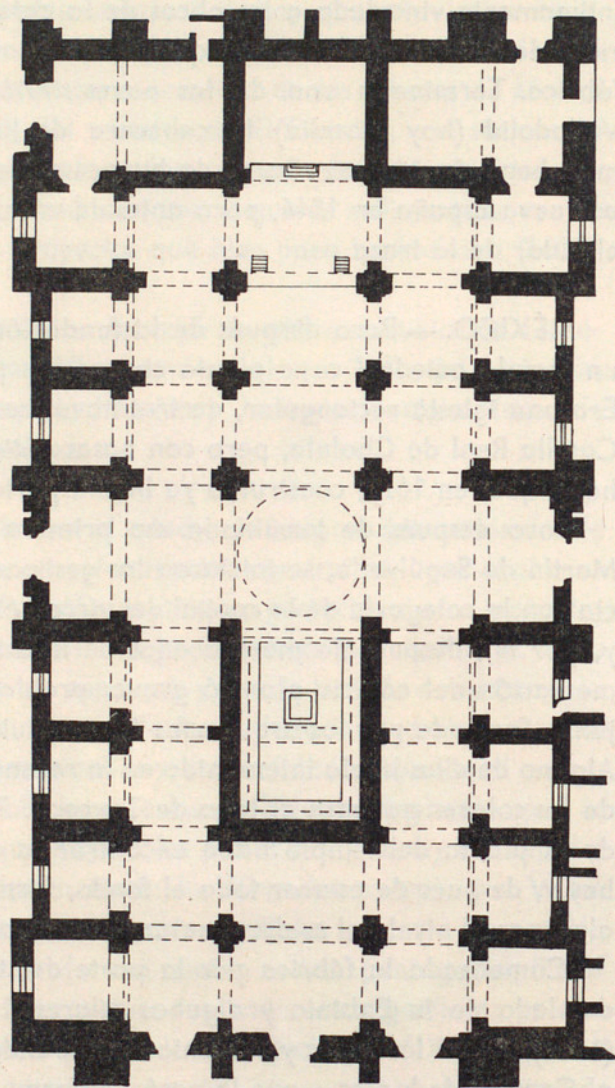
PLANTA DE LA CATEDRAL DE PUEBLA. Según Toussaint.
